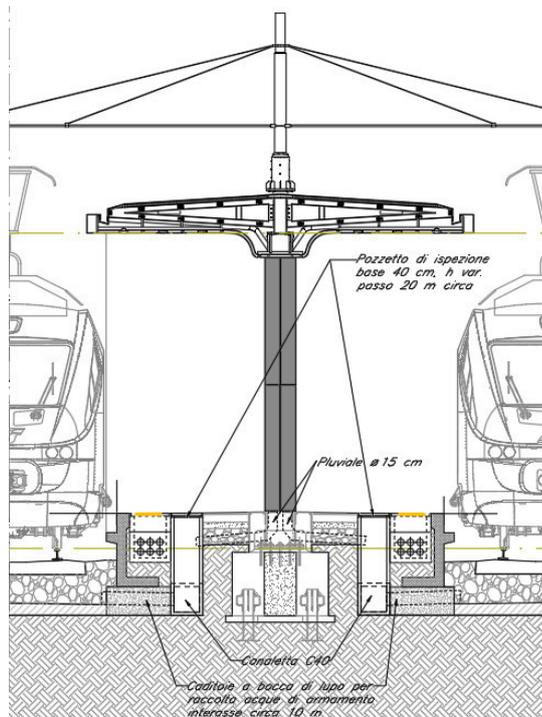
Dettaglio drenaggio nelle banchine di stazione
